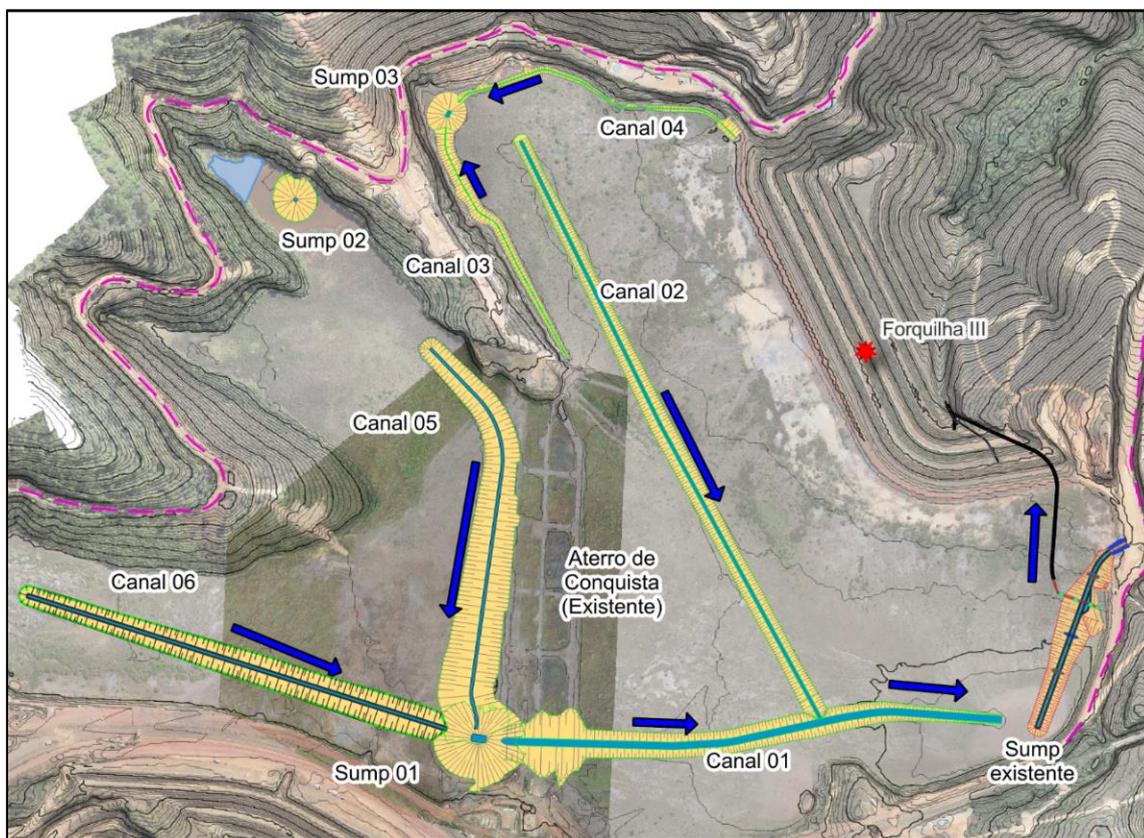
Arranjo geral do plano de chuvas 2024/2025, Projeto INTT – Obras previstas para serem executadas no período seco de 2024.
